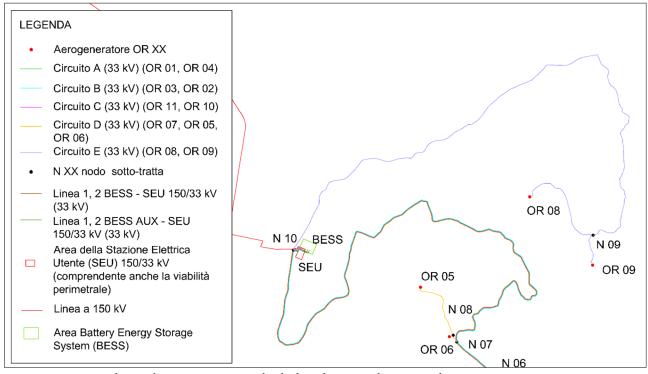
Dettaglio 2 planimetria generale di distribuzione linee a 33 kV
